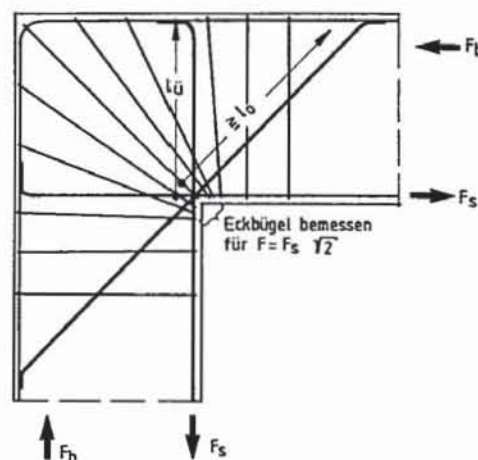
Beispiel für die Ausbildung einer Rahmenecke bei positivem Moment. Die Biegezugbewehrung ist nicht schlaufenartig geführt.
